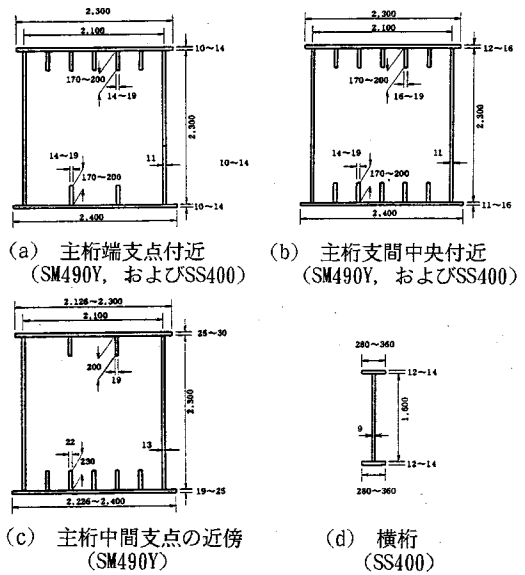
解析モデル-2の部材断面形状・寸法(寸法単位:mm)
